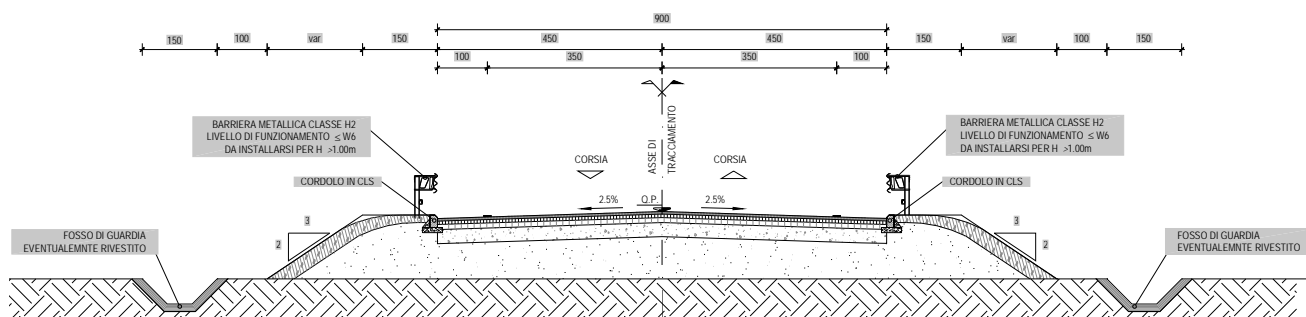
Esempio di sezione di tipo F1 in rilevato e in rettilineo.
